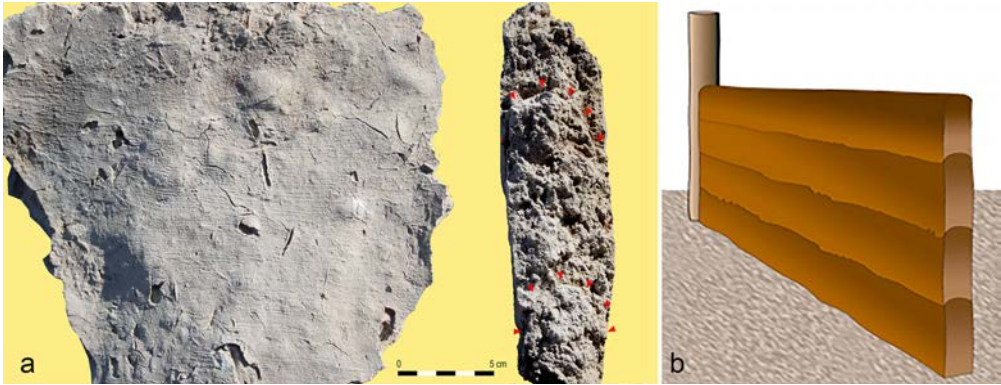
a) Plancha de manteado machihembrado y sección con indicación de los contactos entre bandas. b) Esquema del sistema constructivo.
